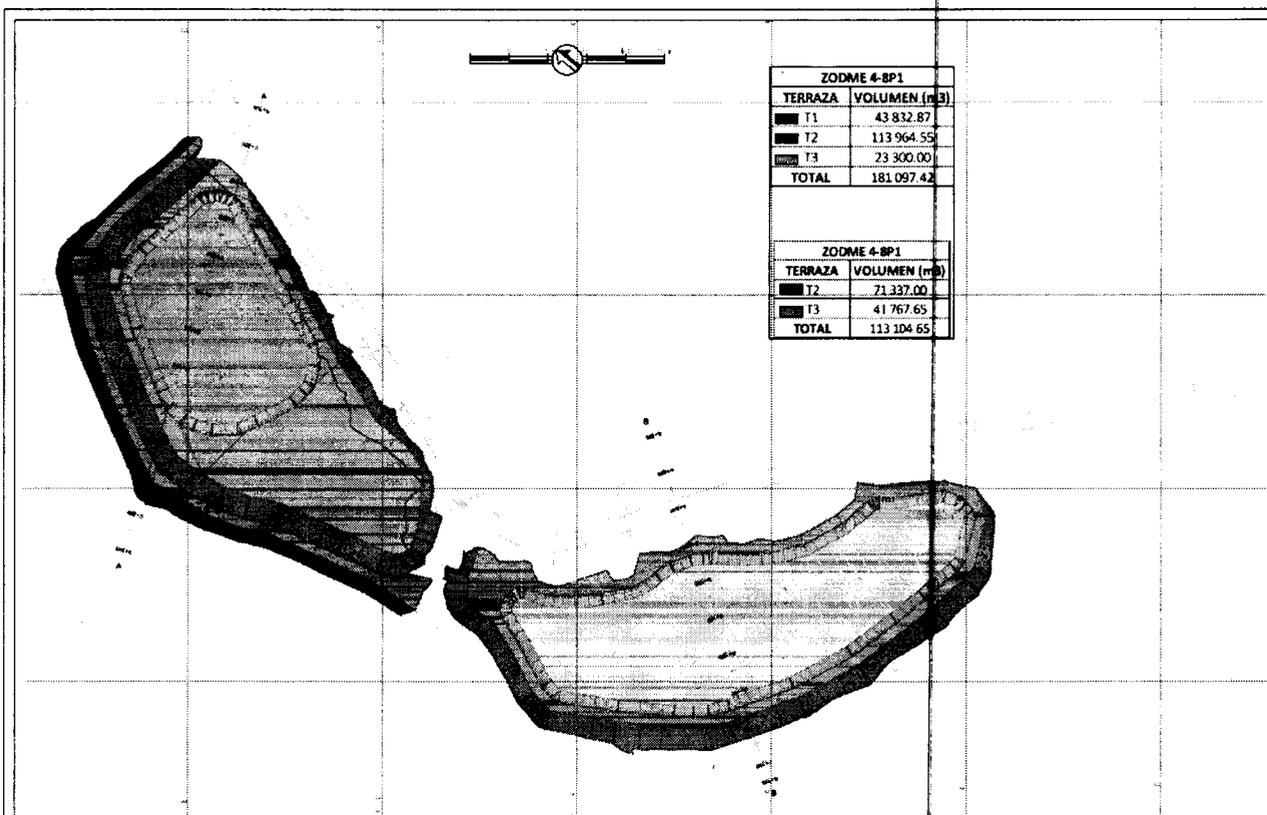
Vista en planta del diseño final de la ZODME 4 - 8 P1 (K18+400).
